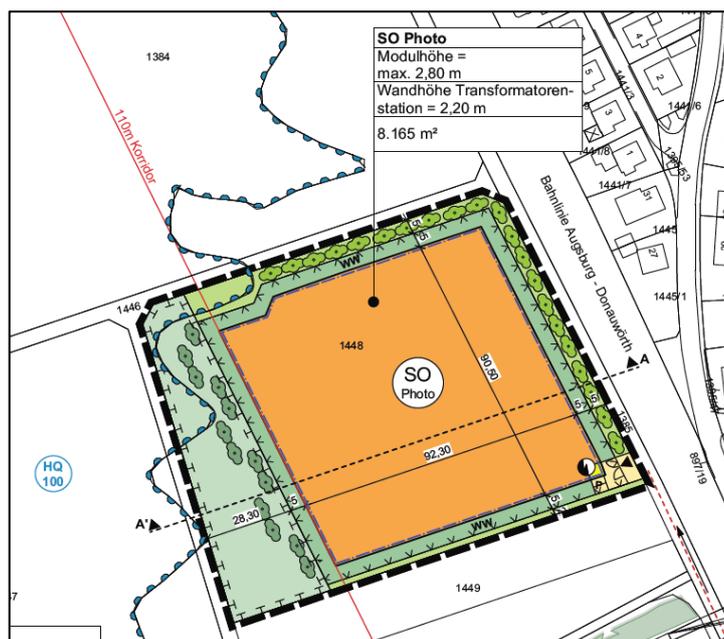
Ausschnitt Bebauungsplan „Solarpark Josef-Dunau-Ring“ in der Fassung vom 28.11.2017 von dem Büro Becker +Haindl Architekten- Stadtplaner – Landschaftsarchitekten, aus Wemding
